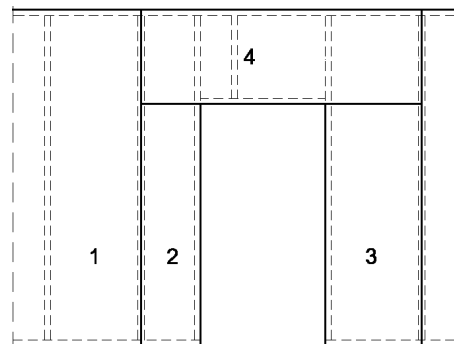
Hueco de puerta con recorte de placa con junta horizontal.
